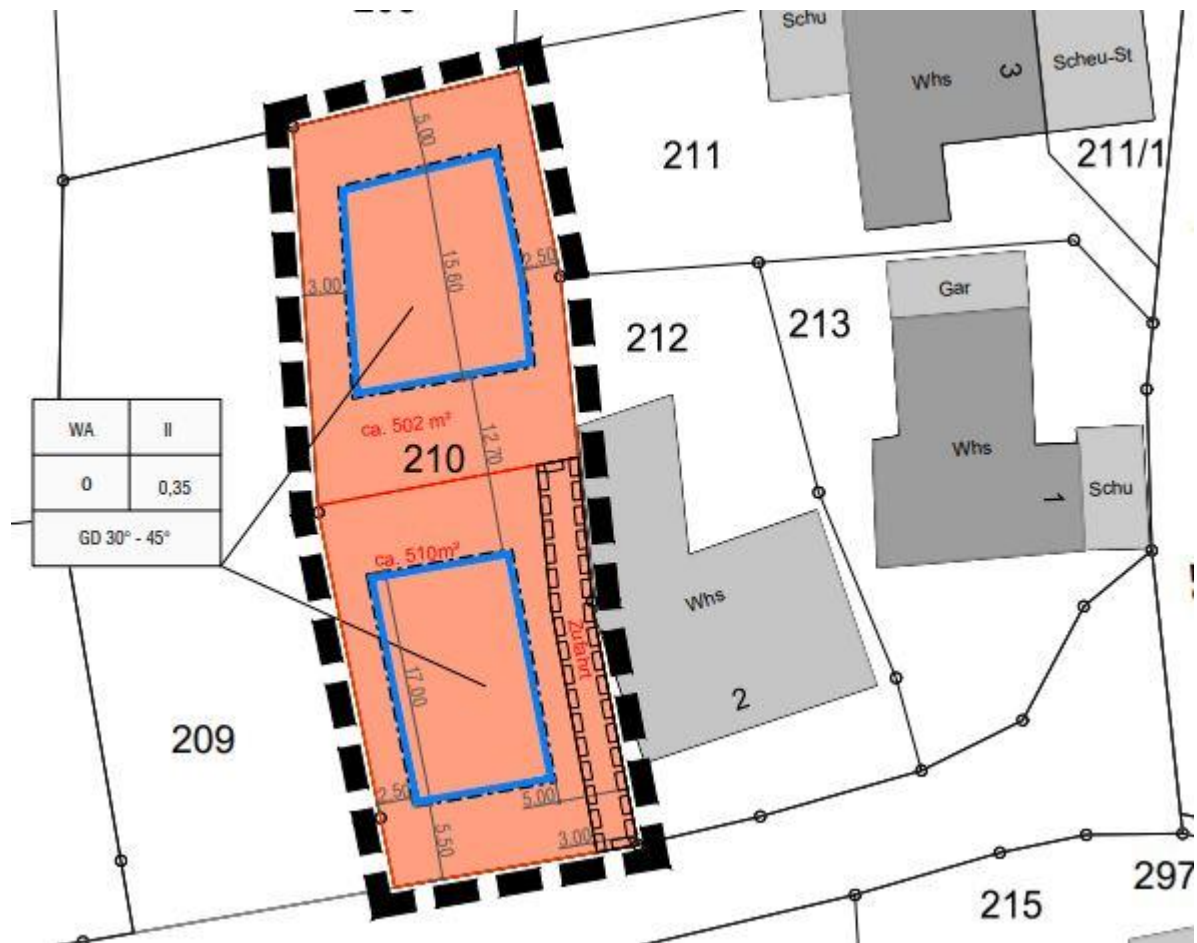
Auszug aus dem Plan der Einbeziehungssatzung (Büro planungfuchs, Mai 2021)
